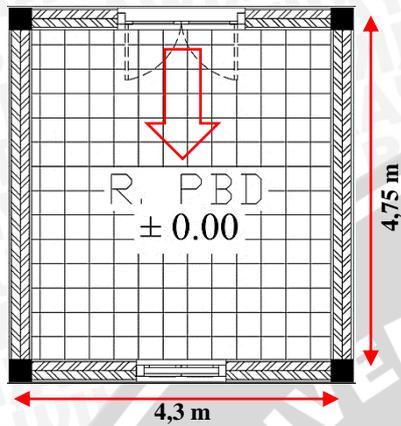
Keyplan dan kondisi eksisting interior KM ruang tamu KS.
